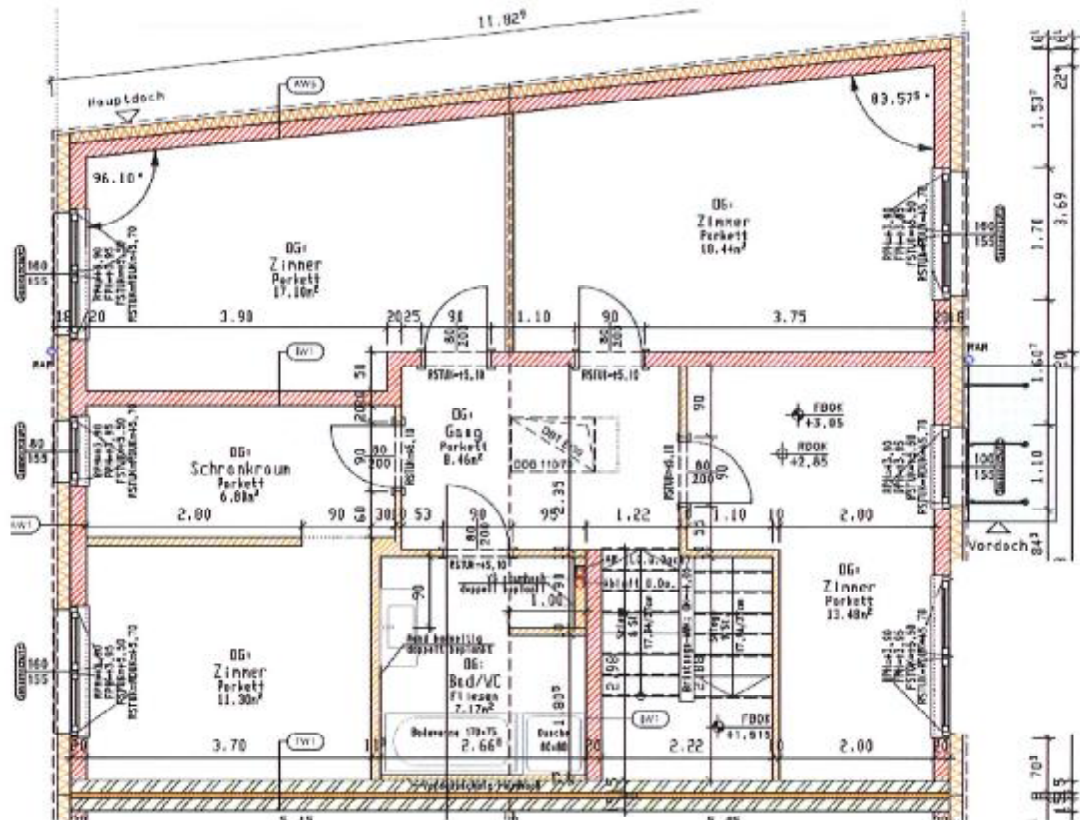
Grundriss 1. Obergeschoß | 21.10.2021
